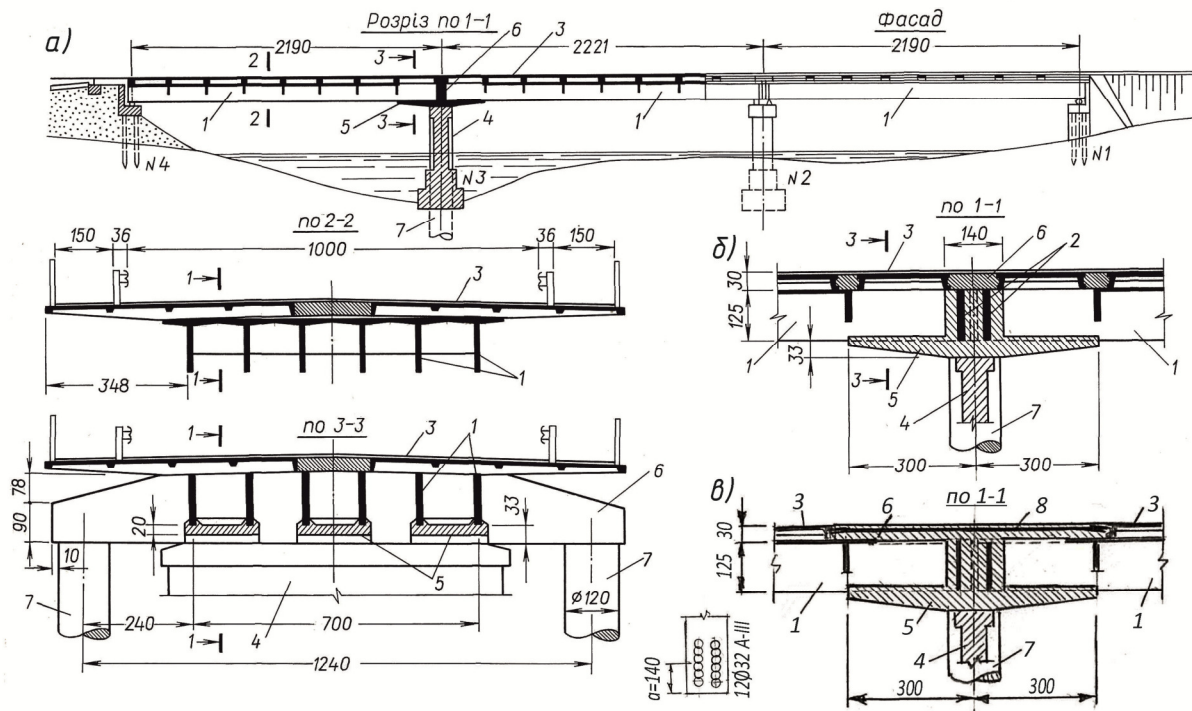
Розширення прольотної будови за ТП вип. 56 моста в с. Лисівці Тернопільської області залізобетонною ребристою накладною плитою з підсиленням проміжної опори № 3: 1 – ребро наявних балок; 2 – опорні діафрагми; 3 – ребристі накладні плити; 4 – опора, що потребує підсилення; 5 – нижня добетонувана плита; 6 – добетонований ригель у межах висоти наявної балки та накладної плити (монолітна вставка); 7 – буронабивний стовп; 8 – відсутня в проекті надопорна арматура.
